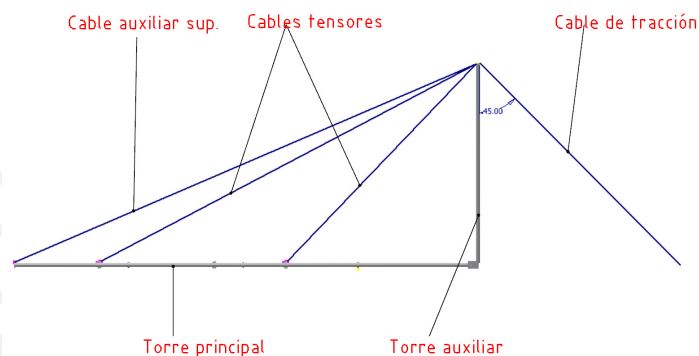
Esquema de montaje (con cable superior auxiliar)
